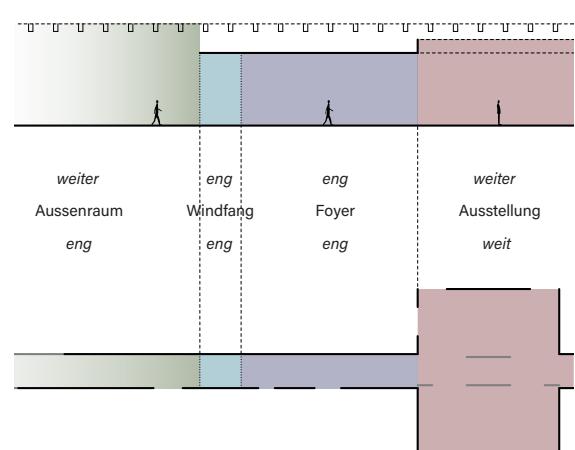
Schema Raumdimensionen Fondation (Autorinnen, 2025))
